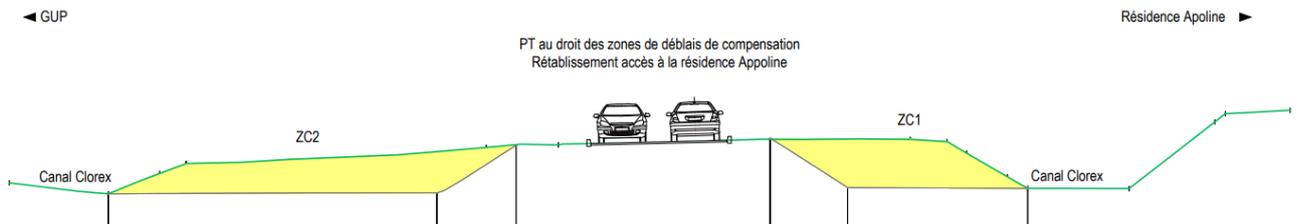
Profil en travers type F au droit des déblais de compensation - (Source : Plan Egis, 12/2022)
